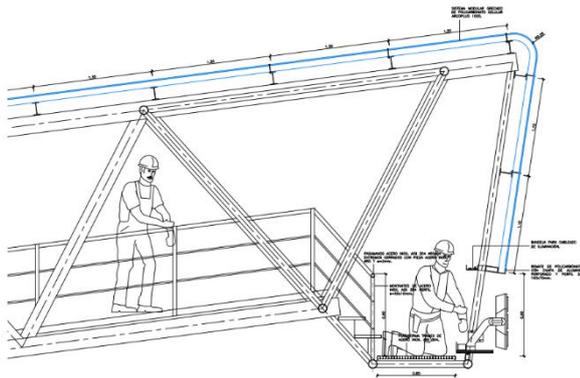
Sección tipo de la pasarela de mantenimiento en el perímetro interior de los laterales. Fuente: elaboración propia.
